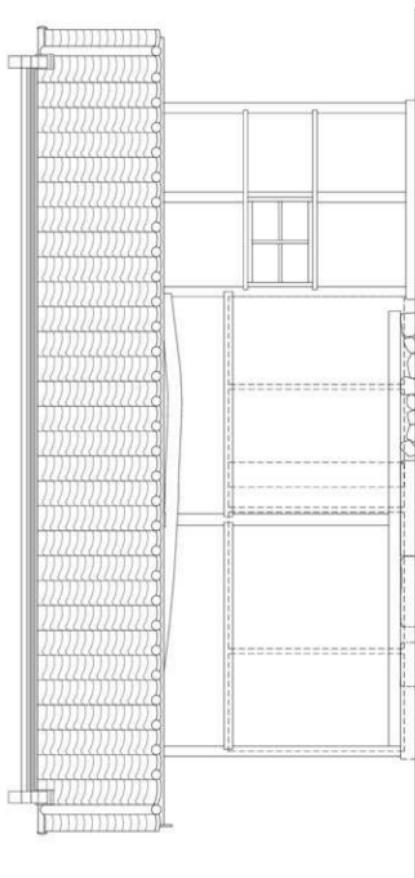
灶屋 修理前 西立面图 $S=1/50$
